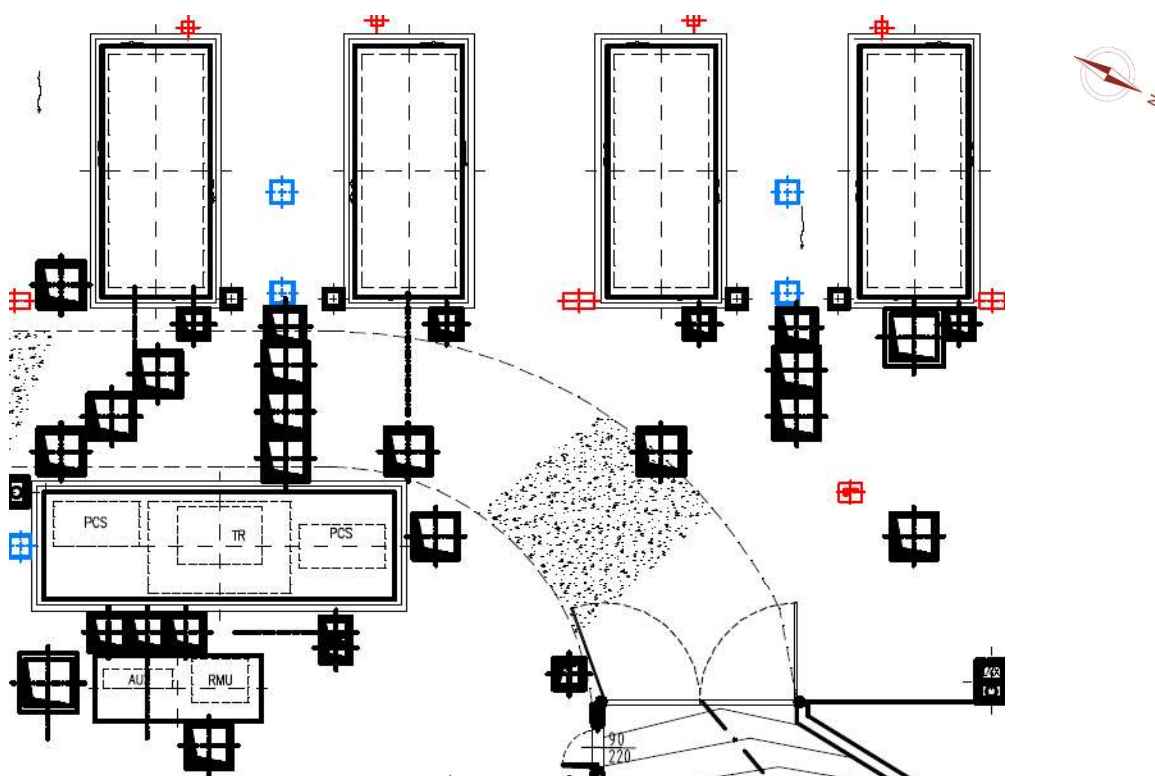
layout impianti di un'isola tipo (area Ovest)
